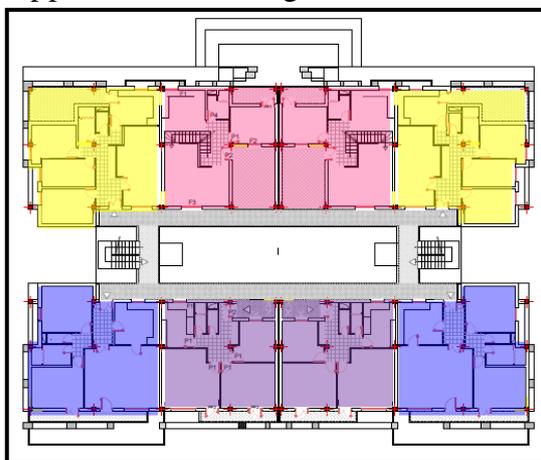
plan 2eme 3 ème 4eme étage source auteur
